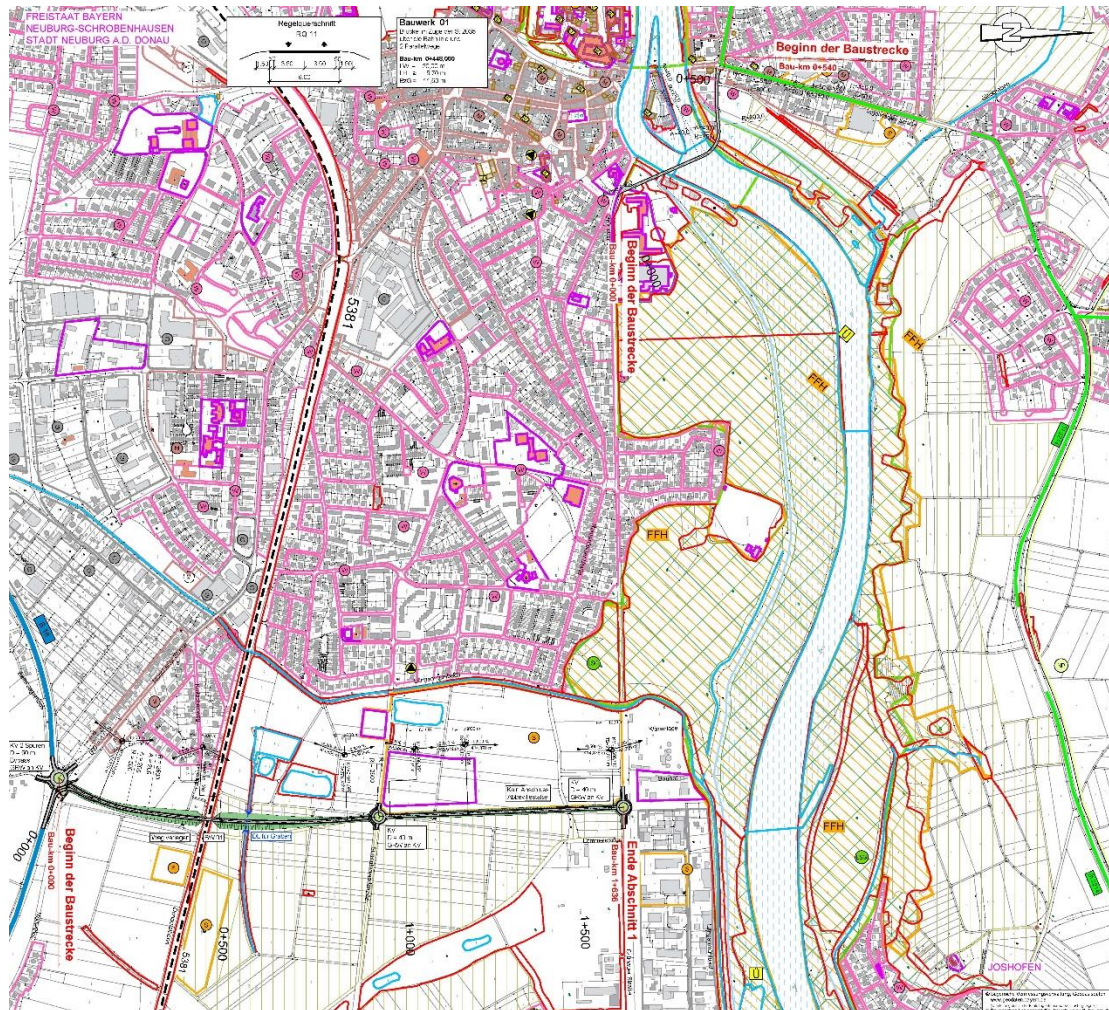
Planfall IV – Zentrumsbrücke mit Grünauer Straße und kleiner Osttangente
